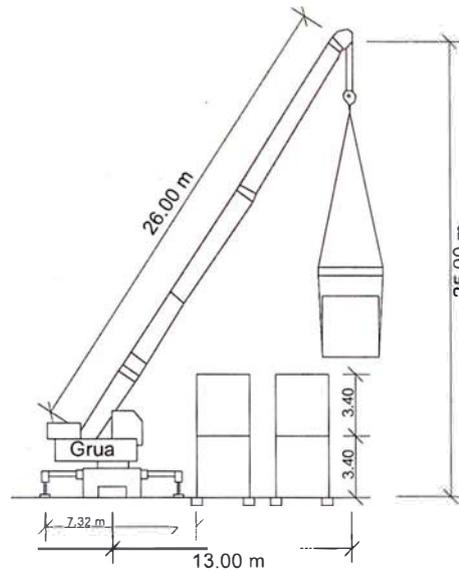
Vista lateral para la elaboración del plan rigging.
